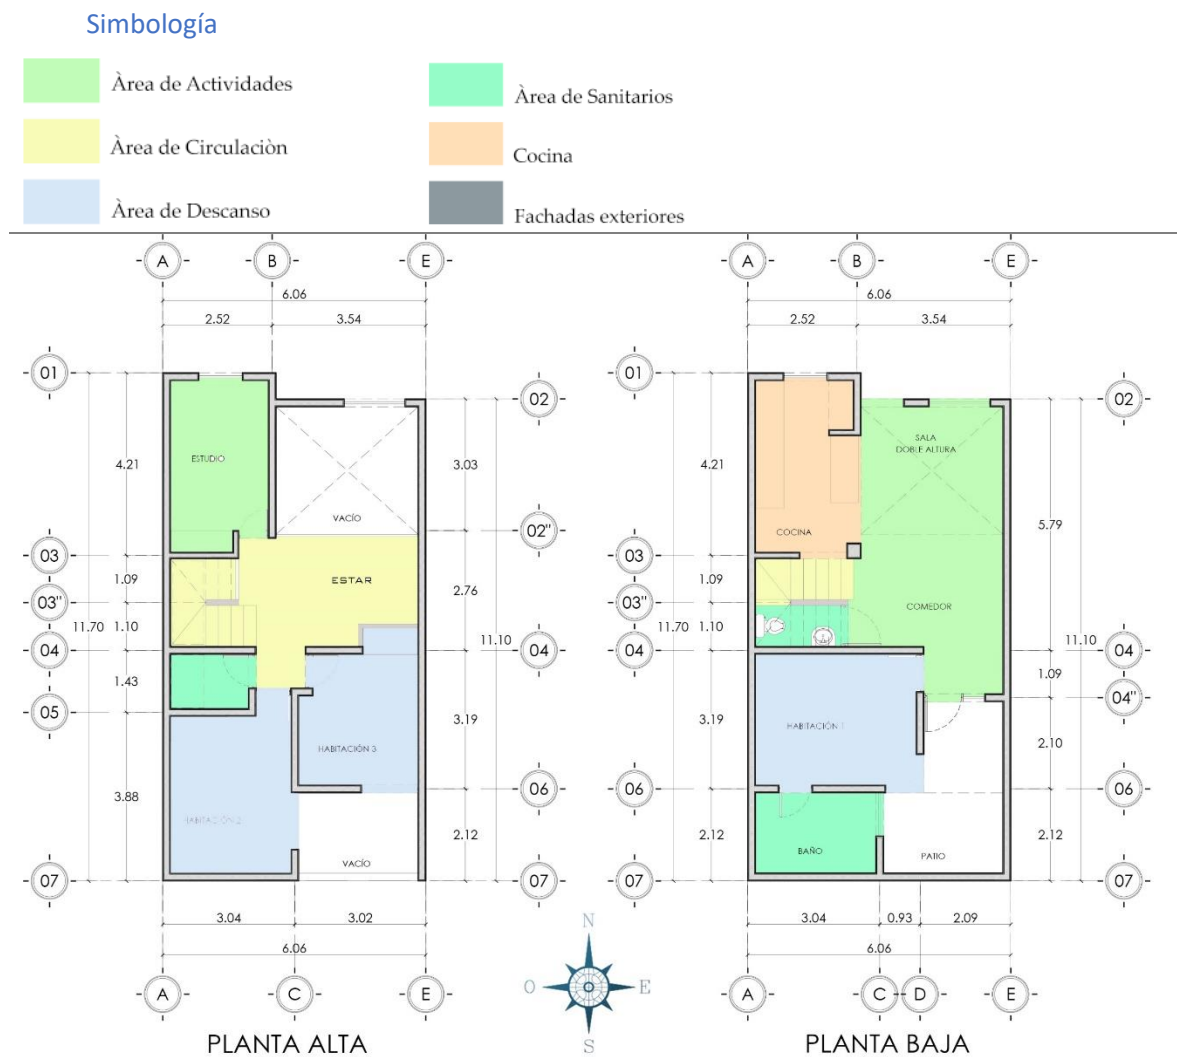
Planta alta y planta baja de la vivienda de estudio
